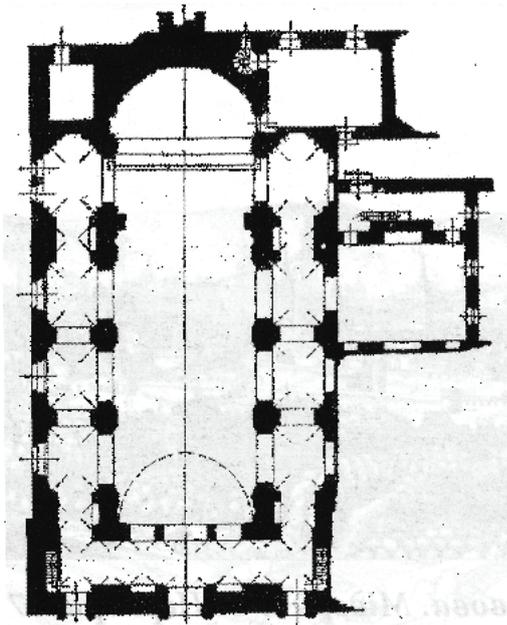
Ehemalige Jesuitenkirche, Grundriss, Lwiw.
